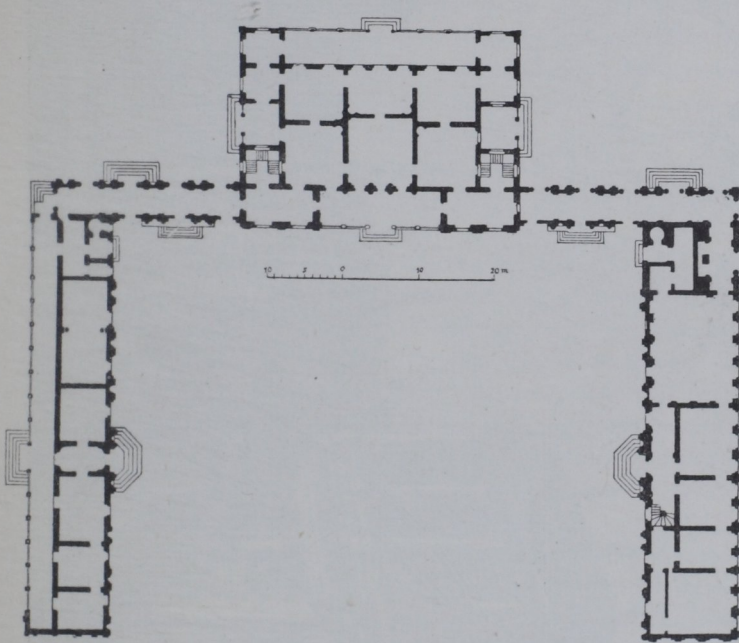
Schloß Willanow bei Warschau. Grundriß des Erdgeschosses.
